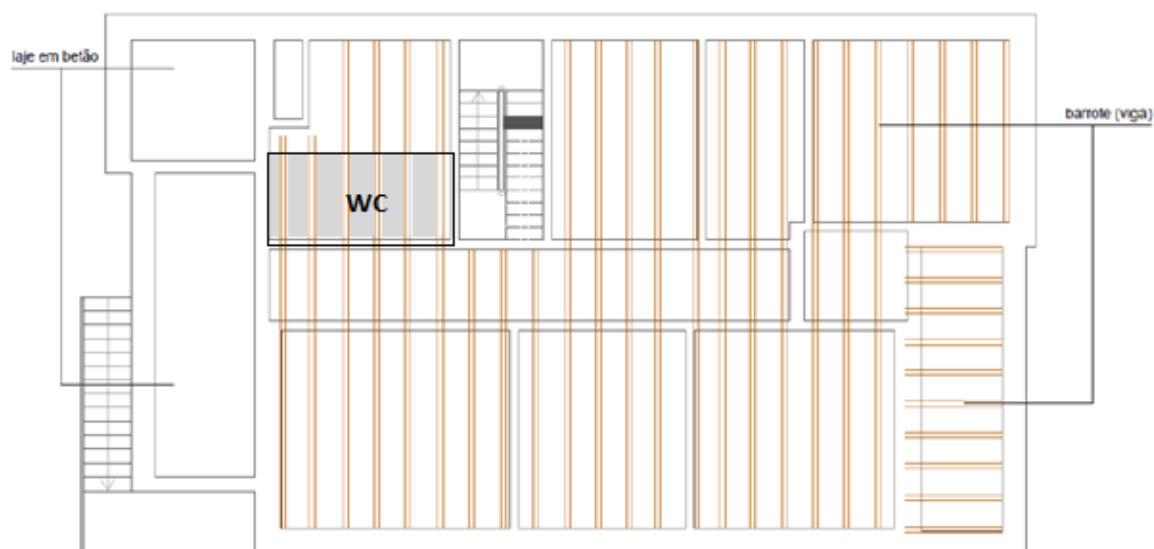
Esquema estrutural da laje do piso 2 com a localização da futura instalação do sanitário modular (demarcado em tons de cinza claro)
